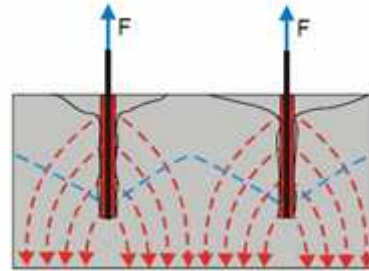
Verankerung ohne Abstützung gegen eine Betondruckstrebe und Lastweiterleitung über Betonzugspannungen (Spieth (2002))
